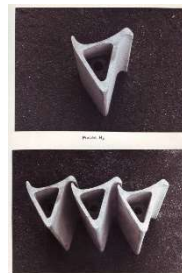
Fisac. Aparejo de vigas hueso (Madrid), 1960
